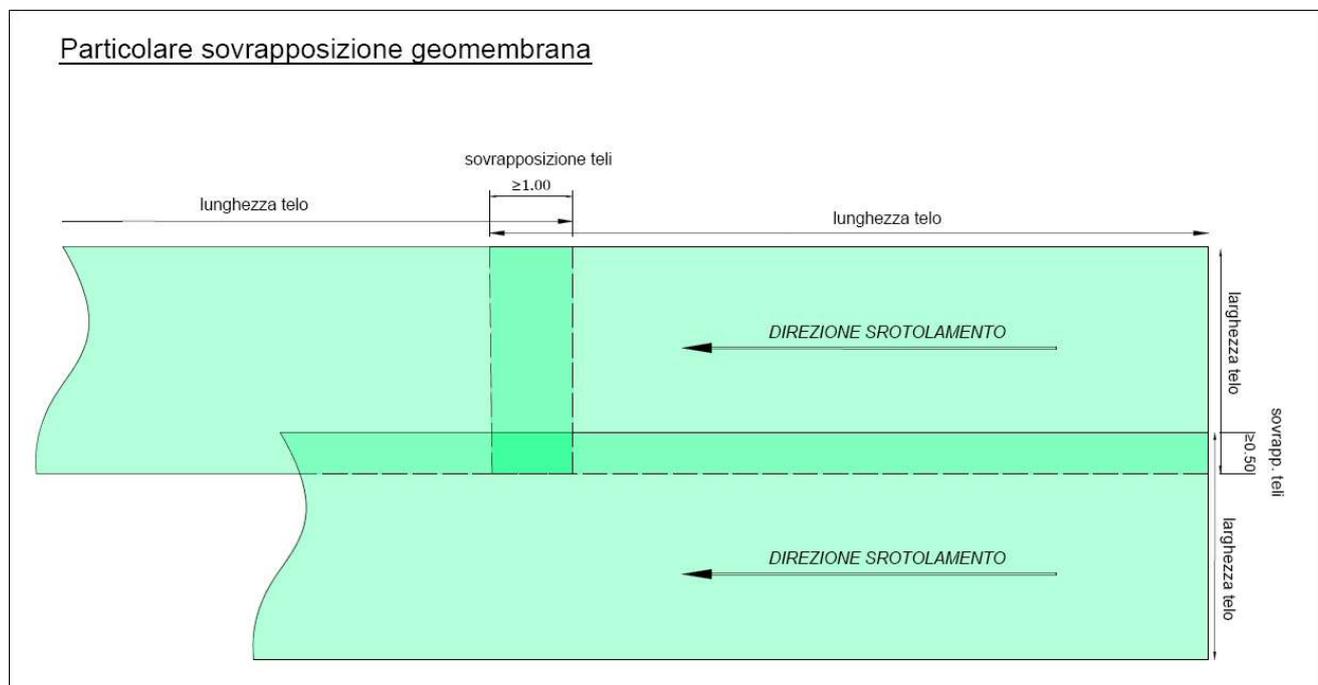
Particolare dello schema di sovrapposizione della geomembrana – pianta
